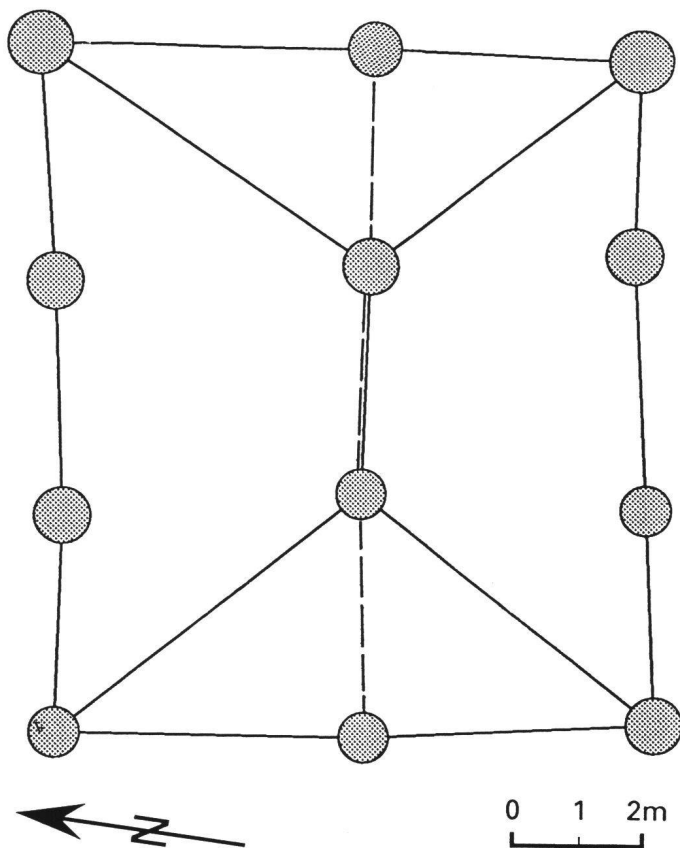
Grundriss des Firstsäulenhauses A. Angenommene Varianten: Vollwalmdach (ausgezogene Striche) und Giebeldach (gestrichelt).
